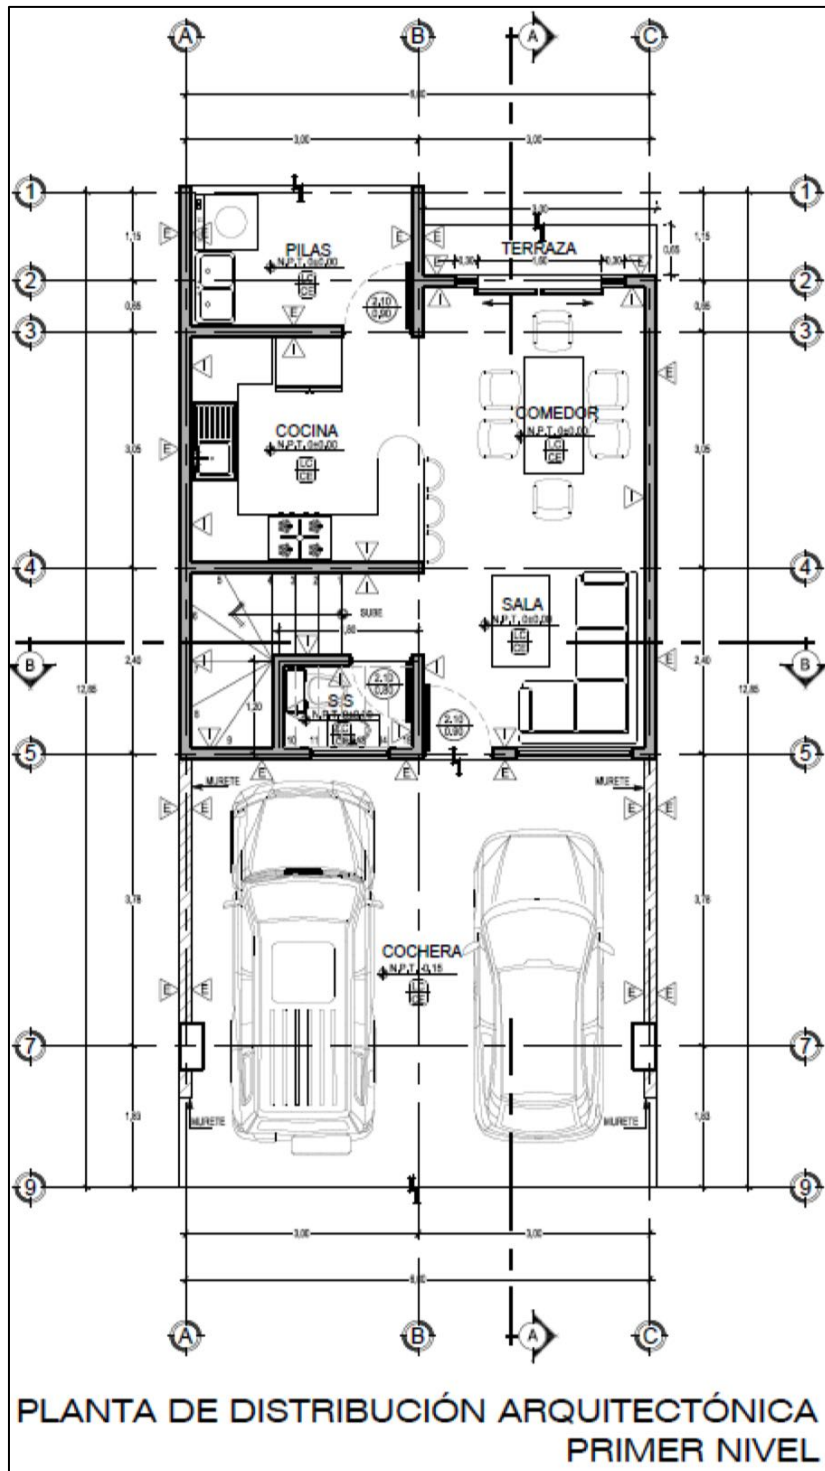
Plano arquitectónico de la vivienda utilizada: Primer Nivel
